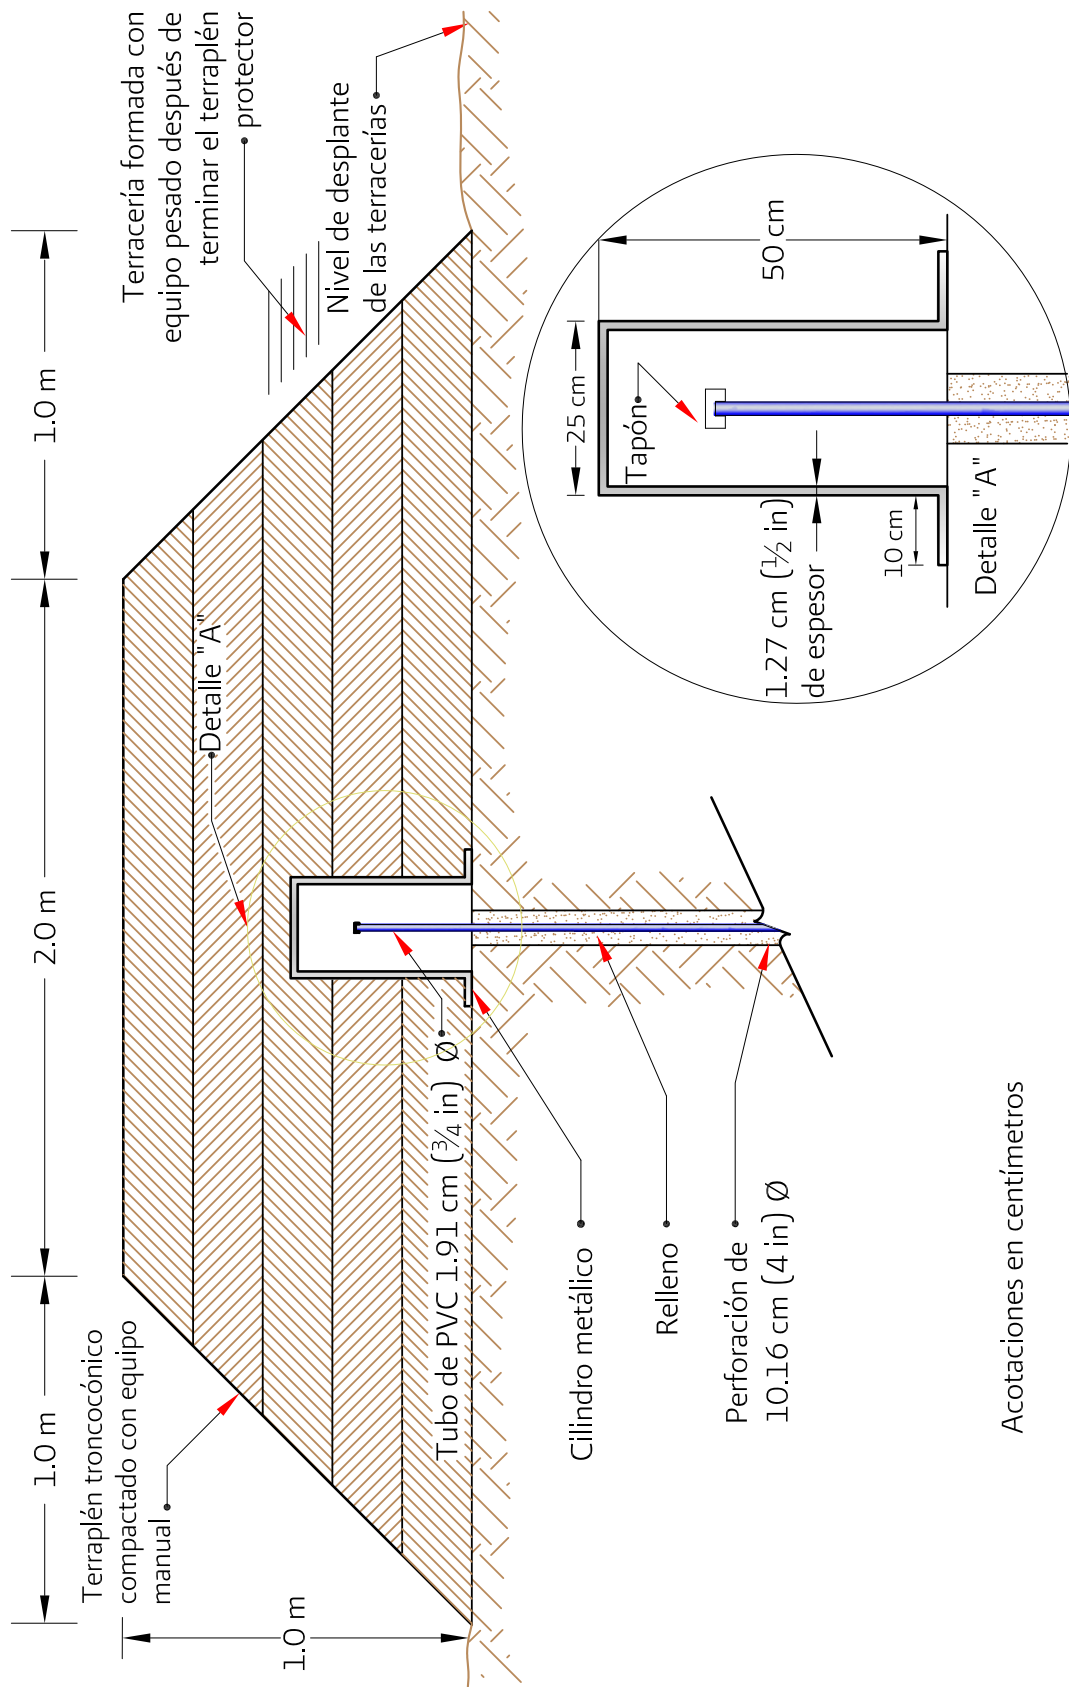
Protección de brocales de tubería de piezómetro abierto con cilindro metálico
